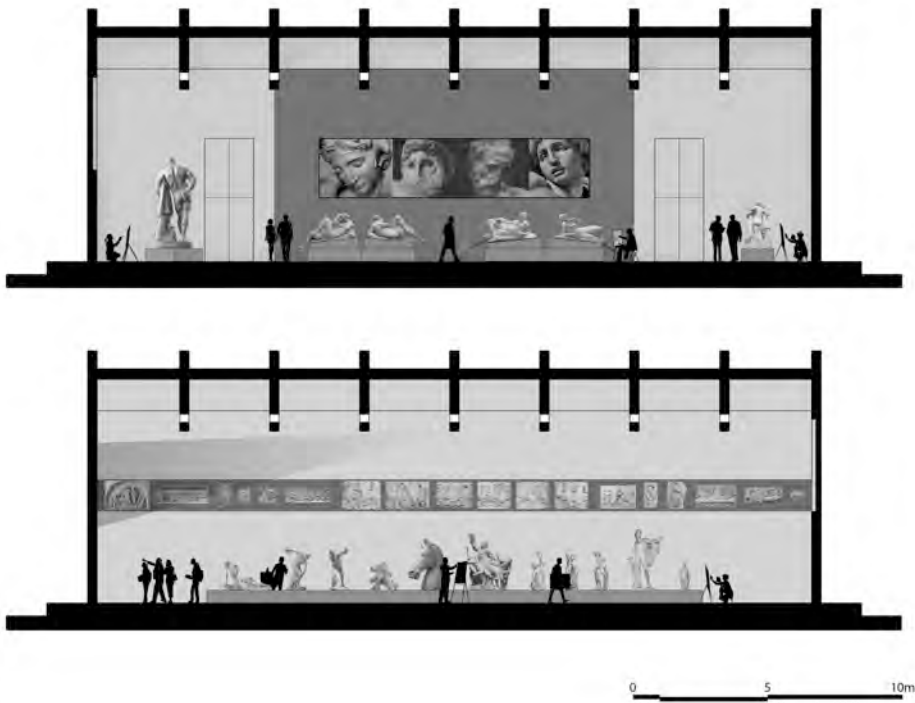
4DGypsoteca, sezioni longitudinali.
